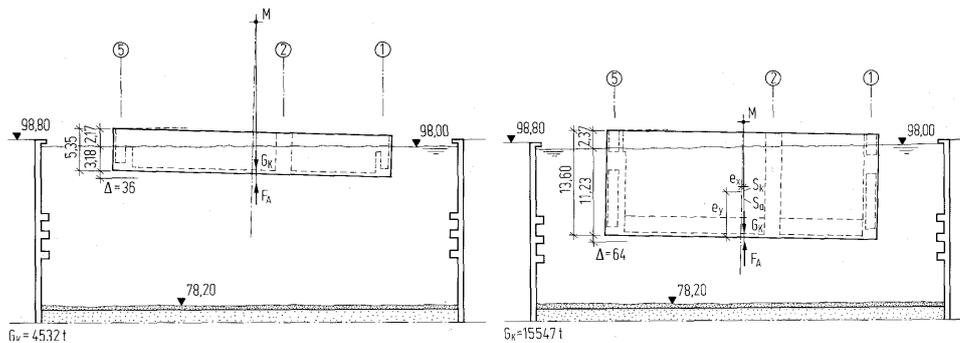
Schwimmender Bau des Senkkastens (repräsentative Bauzustände) [4]
